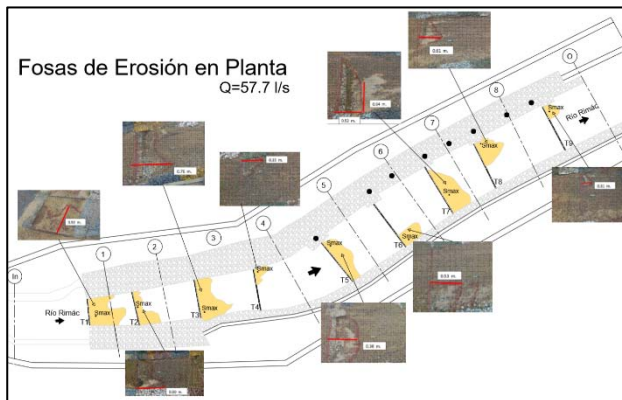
Esquema donde se muestran las traviesas y la forma de las fosas de erosión en planta.
